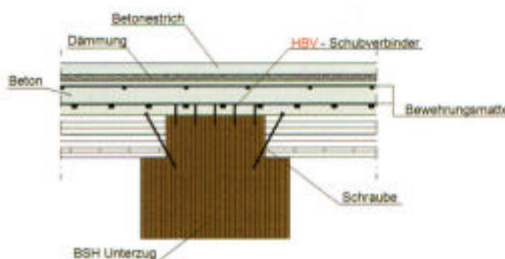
Querschnitt Unterzug und Deckenanschluss
